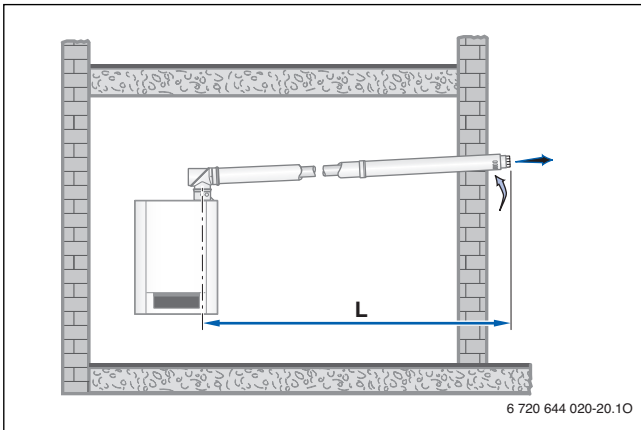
Montážní varianta se stavební sadou GA-X + GA-K + ÜB-Flex
